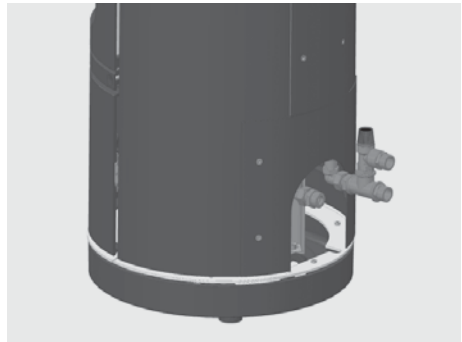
Installationsbeispiel: fertig montierter Anschlusssatz
